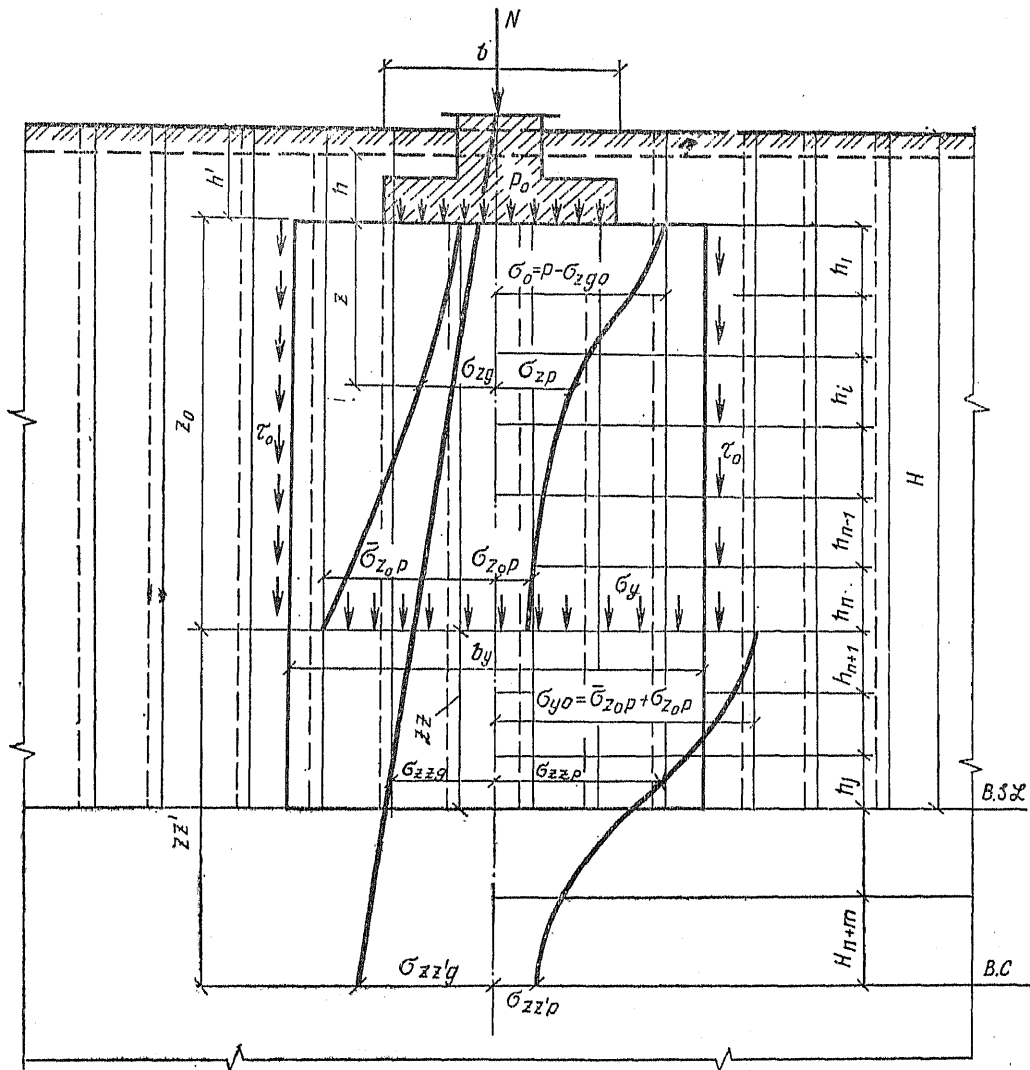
К расчету осадки фундамента на закрепленном методом силикатизации лессовом массиве
